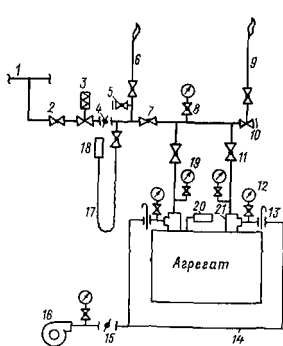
Схема обвязочных газопроводов среднего давления агрегата, оборудованного горелками с принудительной подачей воздуха и отключающими устройствами — кранами.
